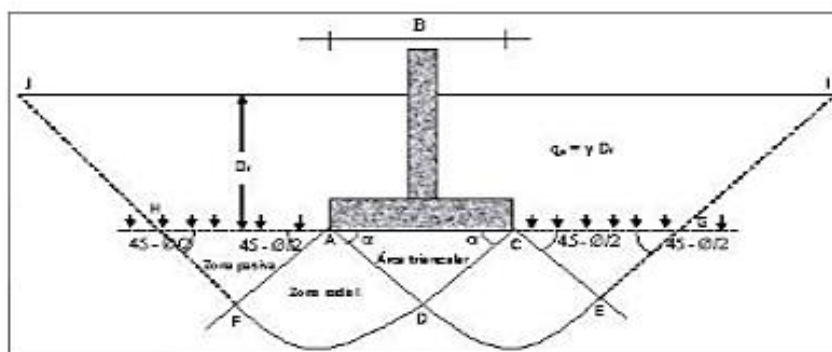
Falla por Capacidad de Carga en un Suelo Bajo una Cimentación Rígida Corrida. (Fuente: Terzagui, 1943).
